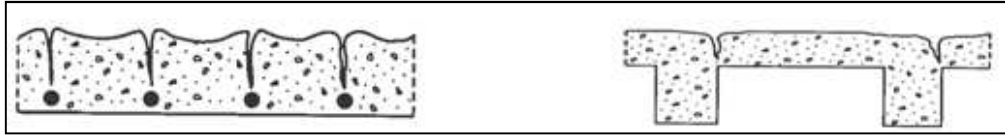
Obstrução de assentamento plástico, formada pela armadura (esquerda) e formada pela geometria da secção transversal (adotado de [8])
